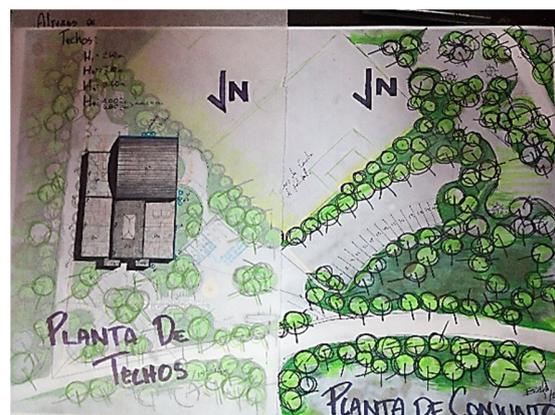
Boceto de los techos del edificio en la planta de conjunto. Elaboración propia.
